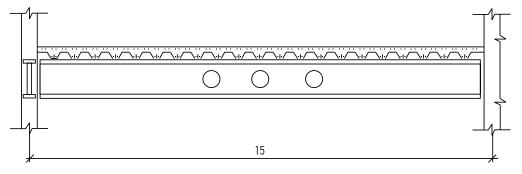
Схема типового перекрытия с длиннопролетными балками, имеющими отдельные отверстия в стенке
